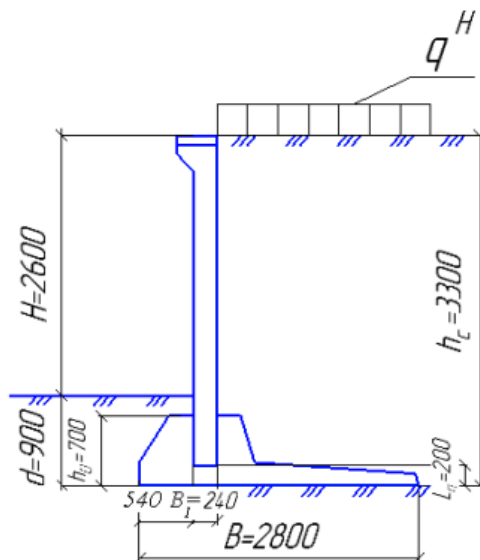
Общий вид тонкостенной подпорной стены из сборных железобетонных элементов
